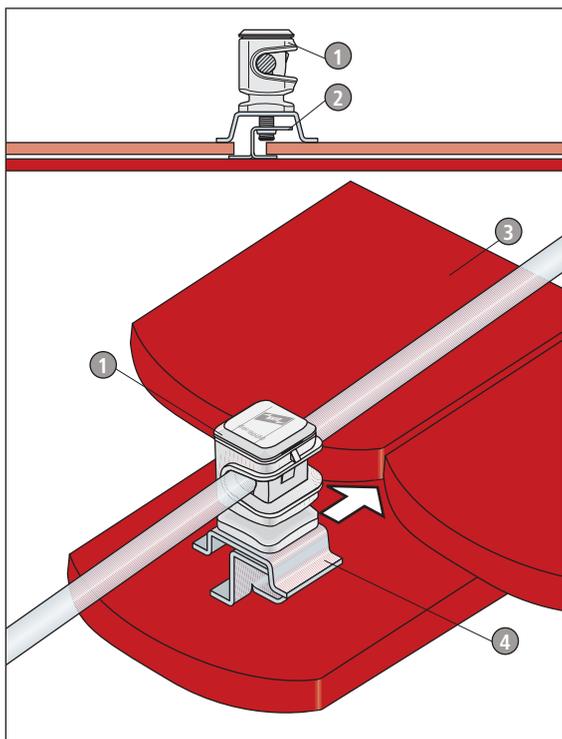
ZIEGELsnap, para sujeción entre tejas o planchas planas.
